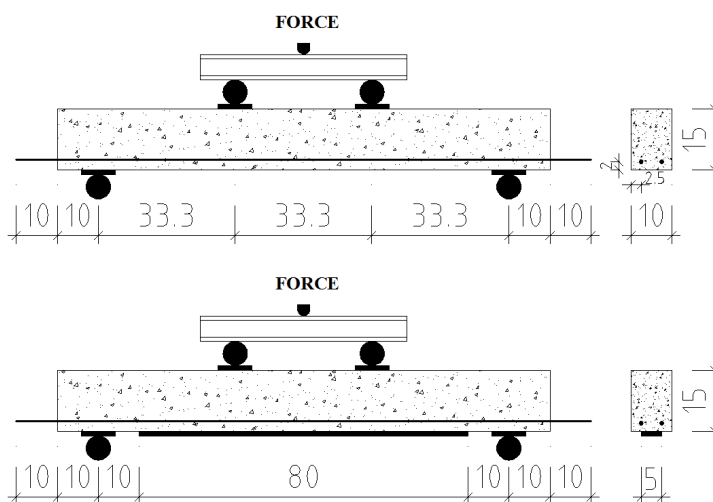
Schema de încărcare pentru încercare a grinzilor la încovoiere: (a) - grinda din beton armat; (b) - grinda consolidată cu platbanda compozită (dimensiuni în cm) / The loading scheme for the bending test of beams: (a) - the reinforced concrete beam; (b) - the plate bonded strengthened RC beam (dimensions in cm).
